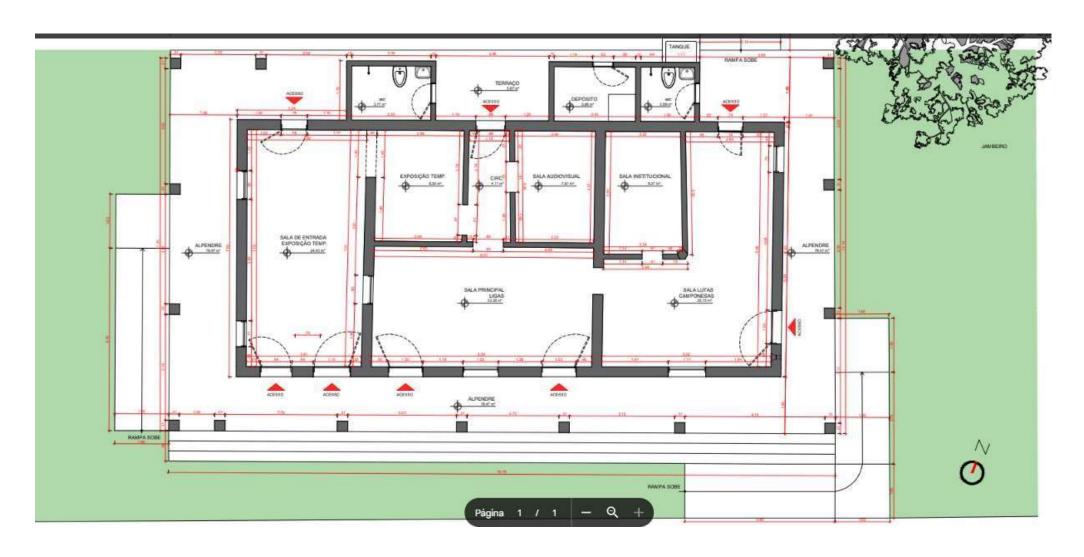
Planta baixa do Centro de Formação. Planta: Nathalia da Silva Azevêdo, CAU nº 100270-8.
